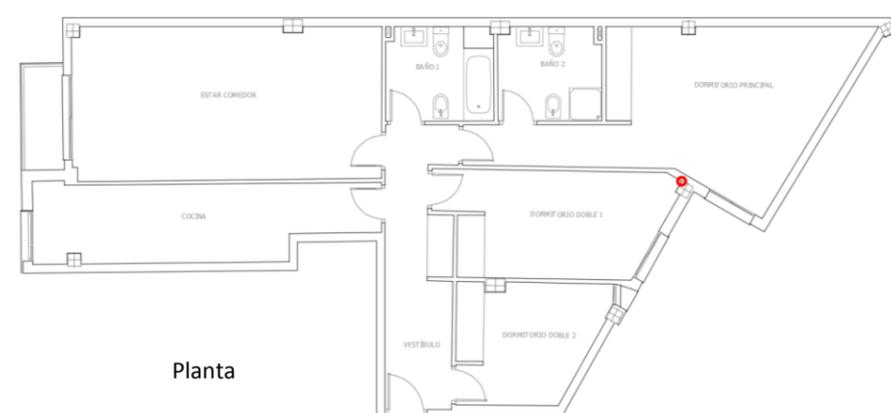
Fisuras grandes/ grietas vivienda 5 planta segunda. 2018. Elaboración propia
